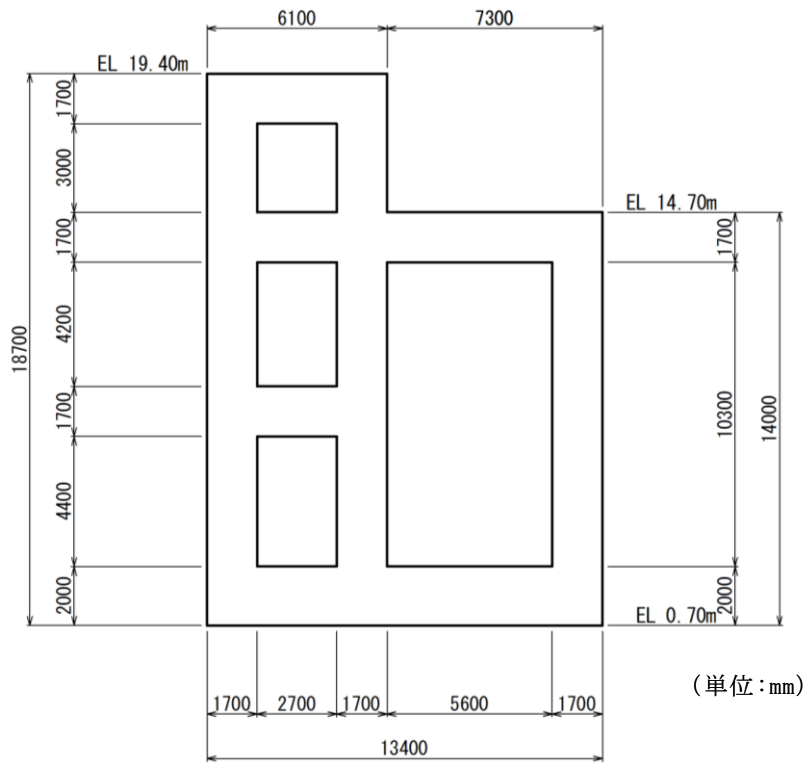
第 1 ベントフィルタ格納槽概略配筋図 (A-A 断面)
